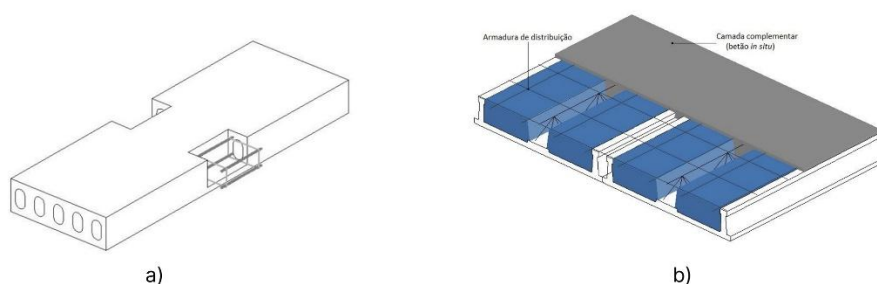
Soluções de armadura para aumento de rigidez em ligações LL: (a) laje alveolar; (b) laje Minos (adaptado de [19])
